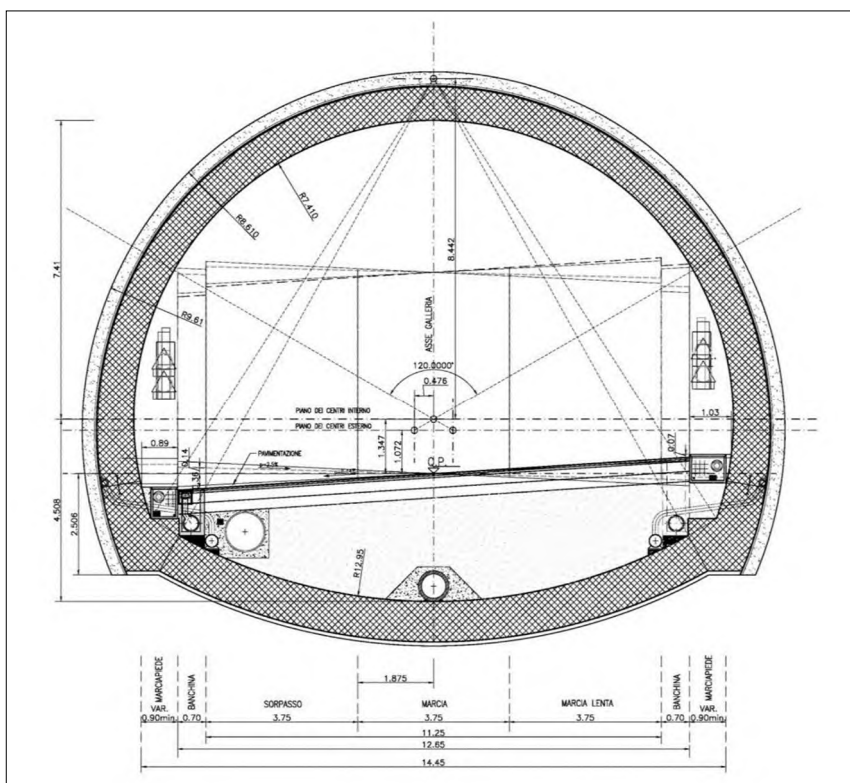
Archittonico nuova galleria Bruschetto in asse Nord (da TUN 1964)
